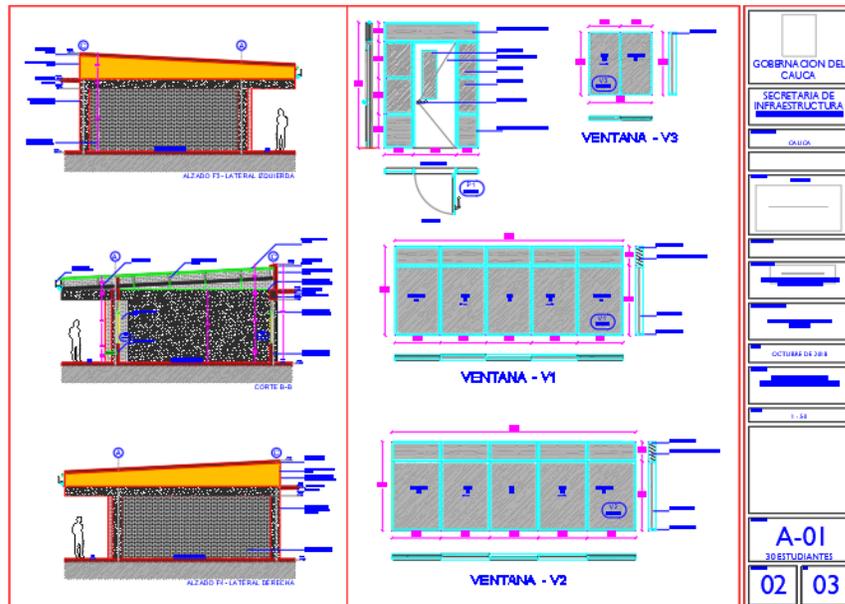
Planos arquitectónicos Aulas escolares. Fuente: Arq. Juan Serrano
